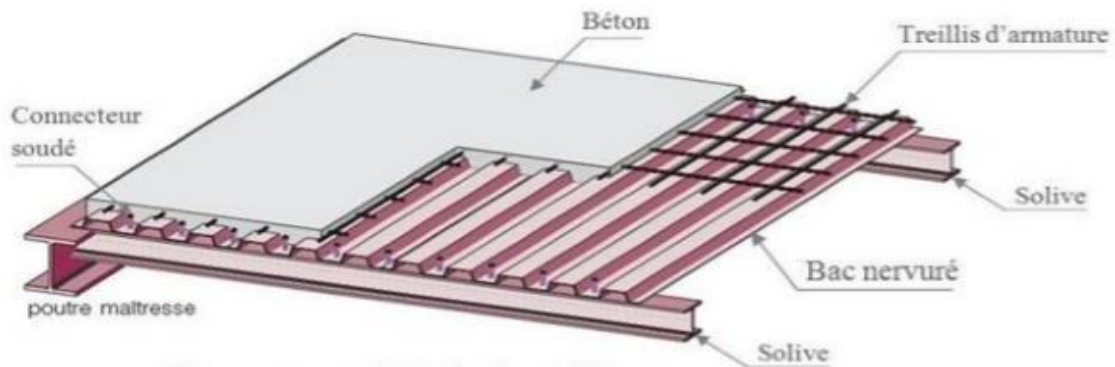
Eléments constructifs d'un plancher collaborant.
